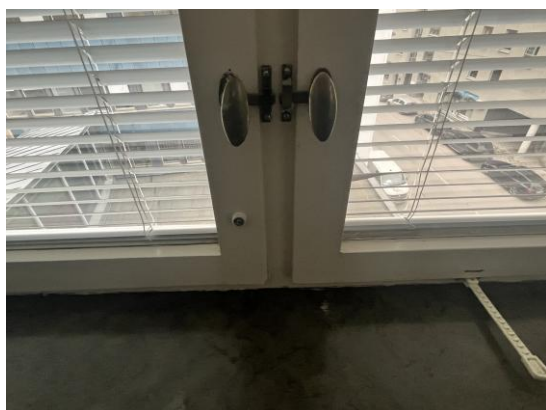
och 11. Ursprungliga träfönster med beslag samt fönsterbänkar av mörk sten är bevarade. Rester av ursprunglig planlösning med arkivrum/våtrumsgrupper med rundade hörn finns bevarad på plan 4.
